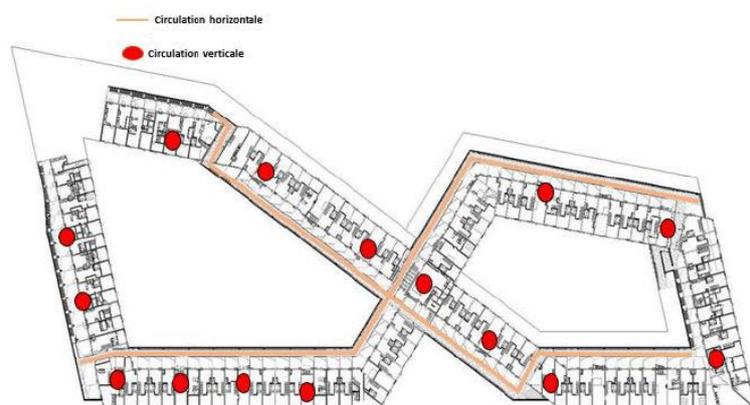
Plan de 9^{ème} au 10^{ème} étages/ Echelle : 1/500
